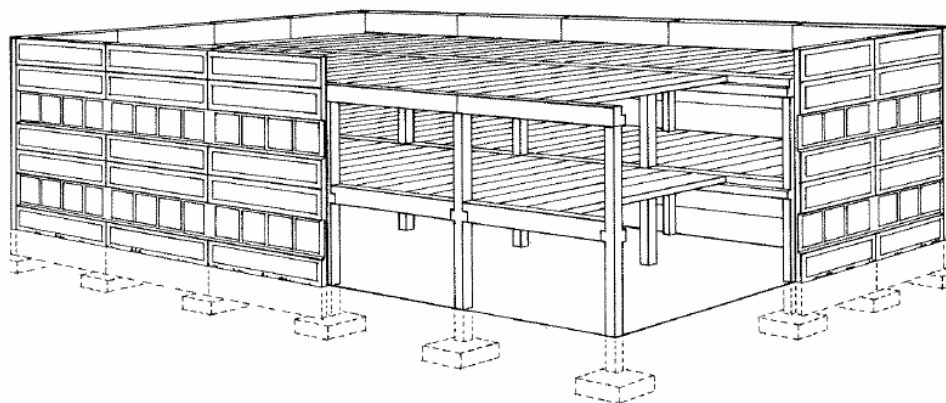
Paredes não estruturais (fachadas) (FIB, 2008)
